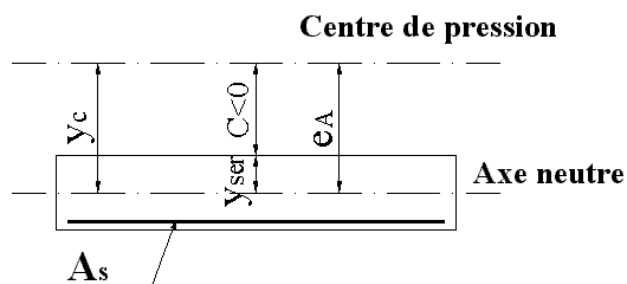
Coupe transversale d'une section de poutre partiellement comprimée.
